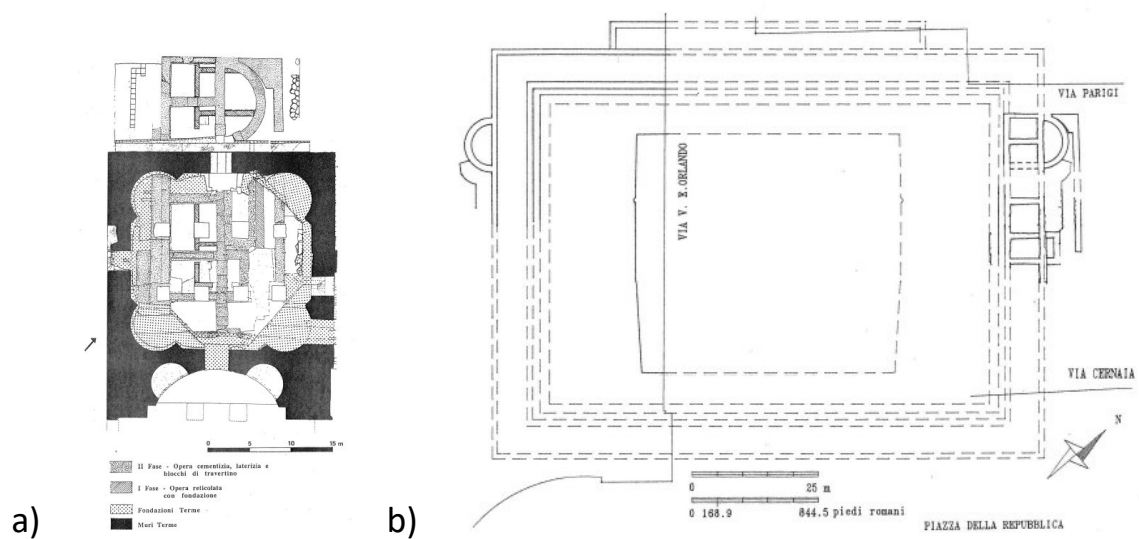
Rilievo dei resti di fondazioni di strutture preesistenti: a) Planimetria dell'Aula Ottogona; b) Ricostruzione estensione edificio preesistente.
